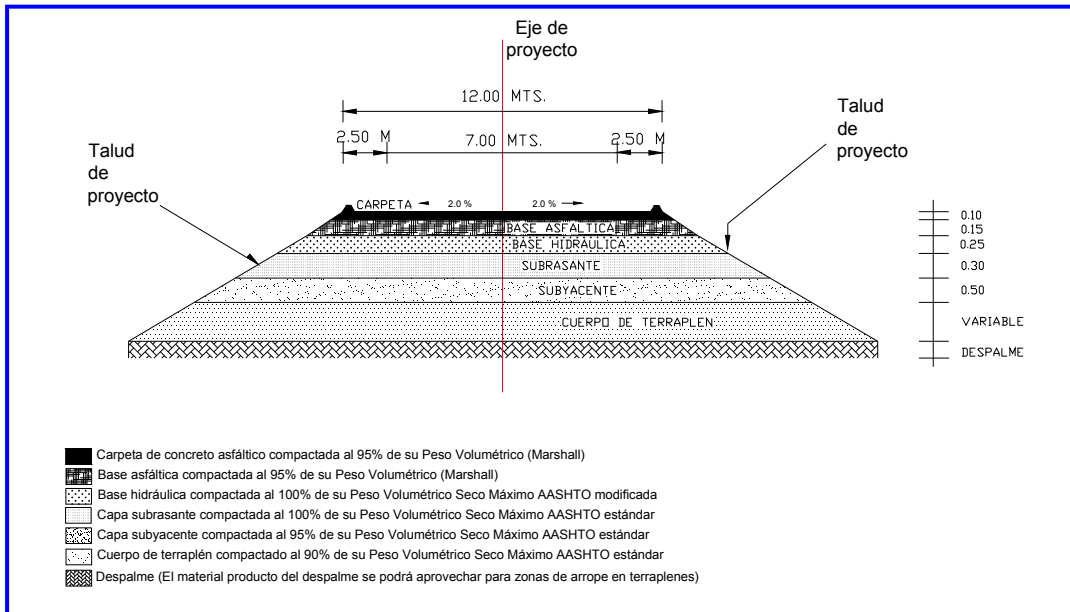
SECCIÓN ESTRUCTURAL TIPO (EN TERRAPLÉN)
